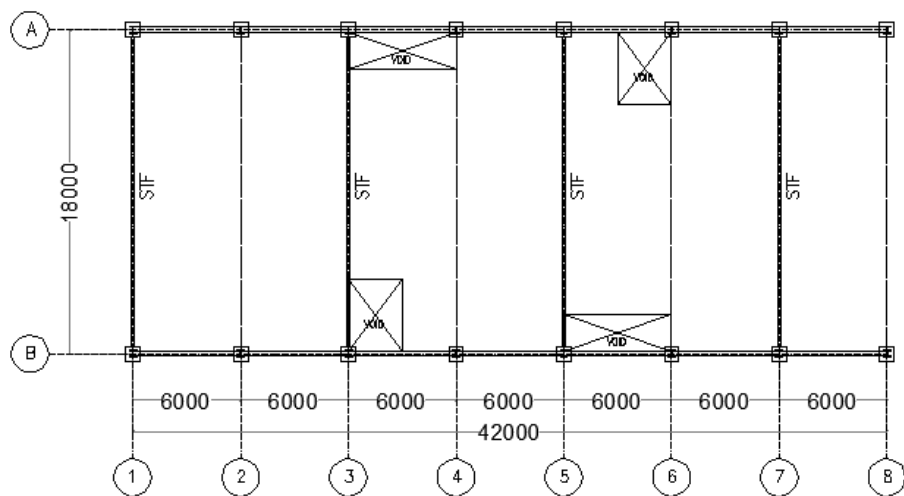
Denah Kolom Lantai 1 Gedung STF 1
